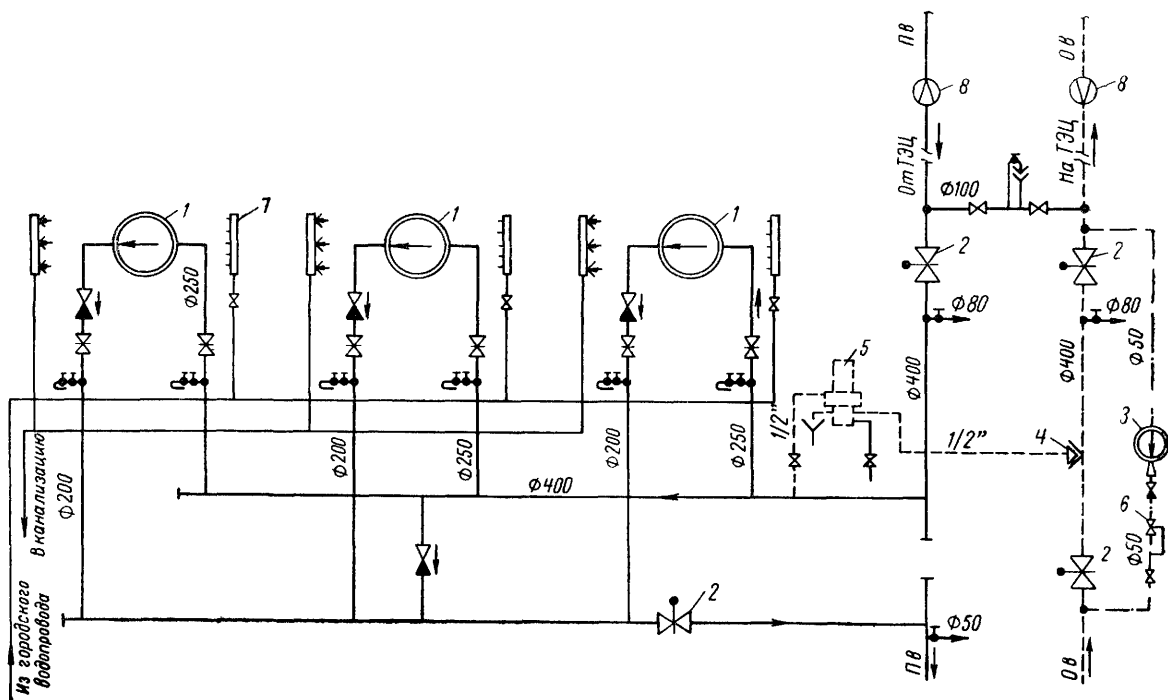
Схема подкачивающей насосной на подающем трубопроводе
